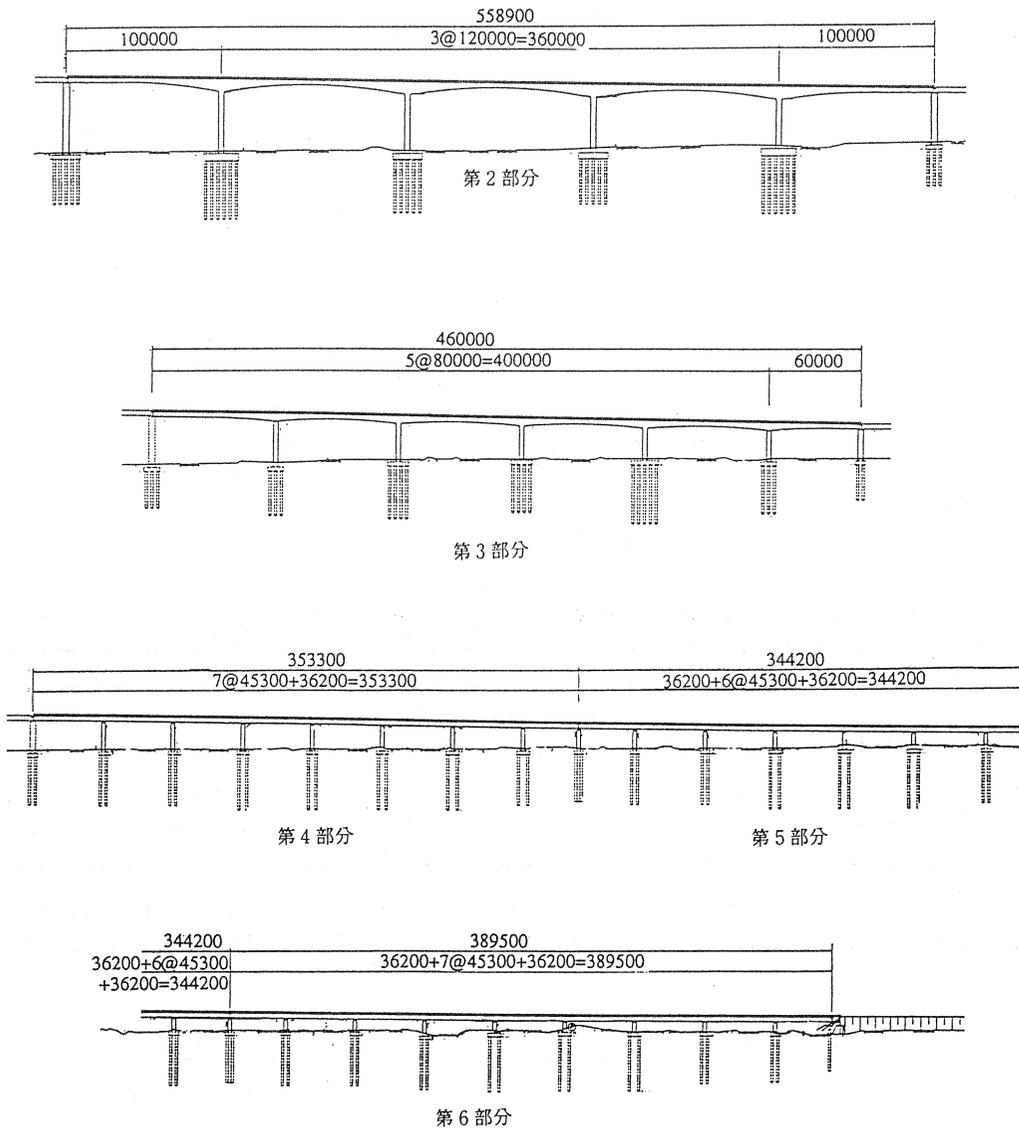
片持ち張出し施工部、移動支保工施工部 一般図
